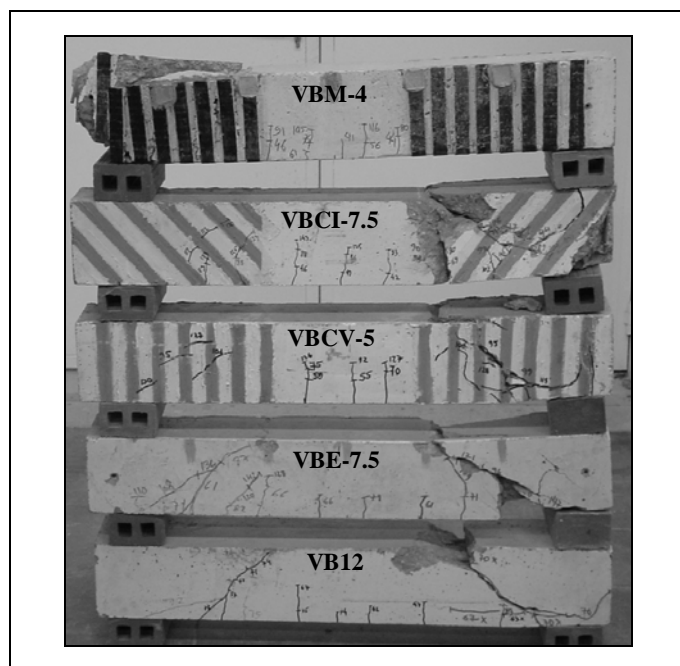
Modos de rotura das vigas da série B com 4φ12 longitudinais.
